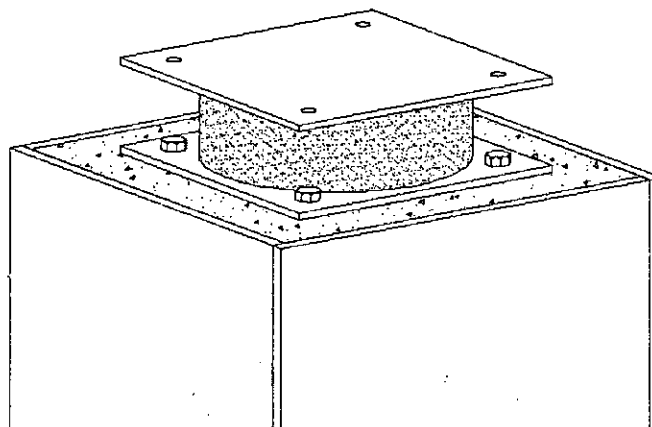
Dispositivo fijado al apoyo inferior (figura referencial)
